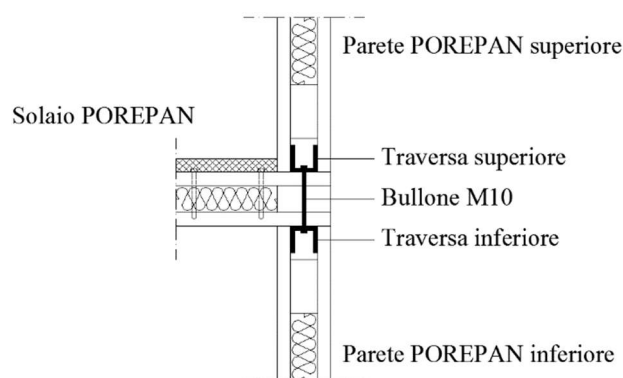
Schema semplificato di collegamento Parete – Solaio - Parete
